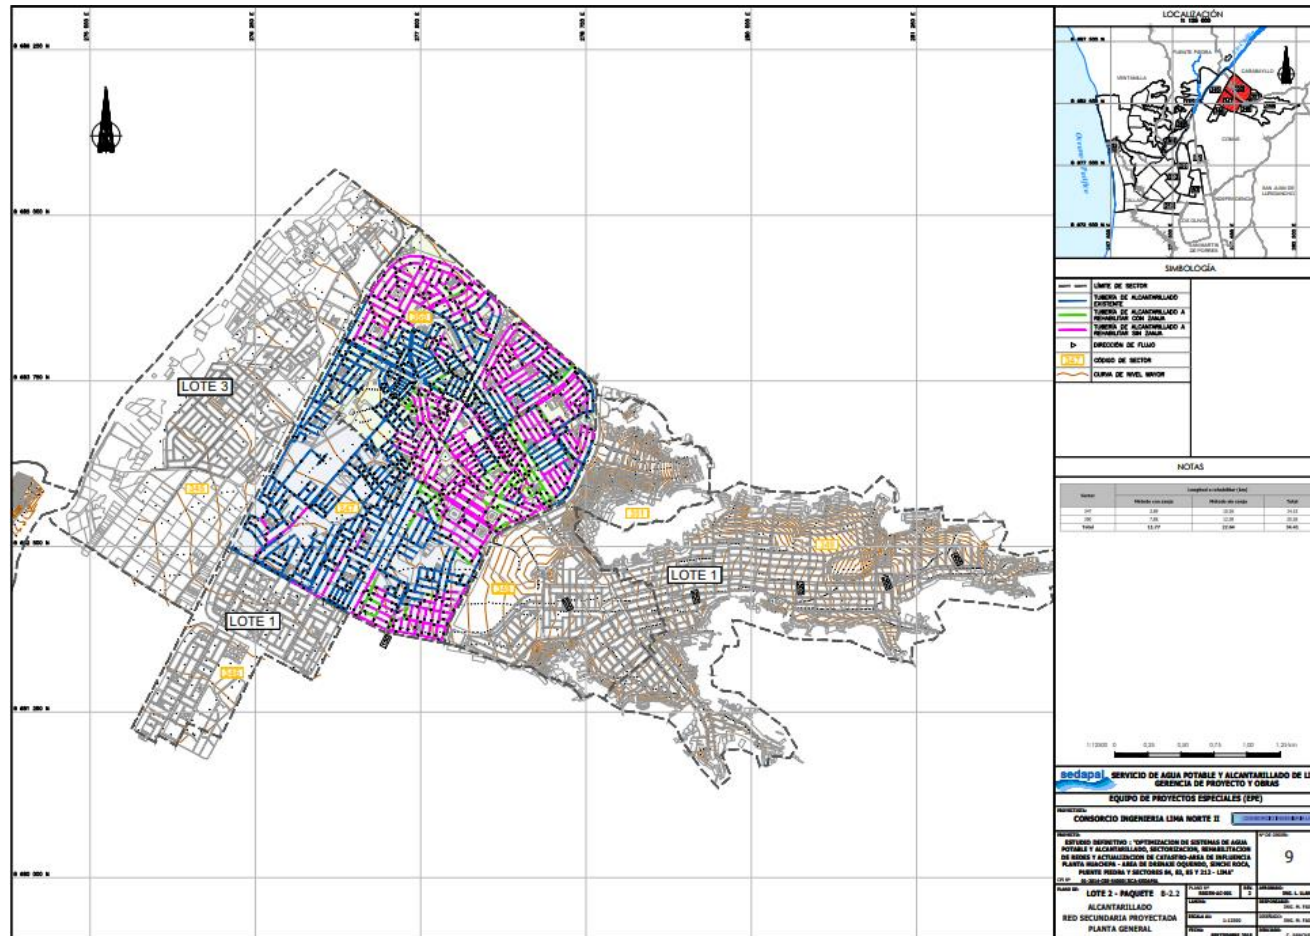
Red secundaria de alcantarillado Sector, 347 y 350
